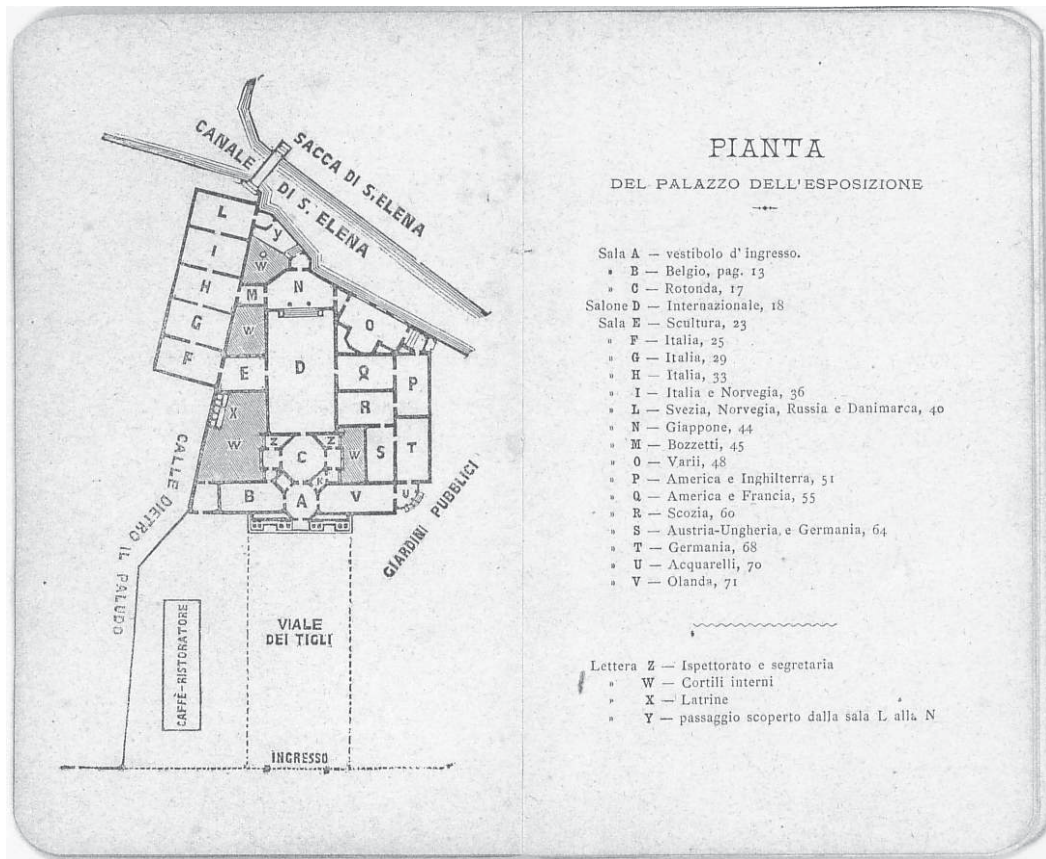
Planimetria dell'area della Biennale nel 1897.
